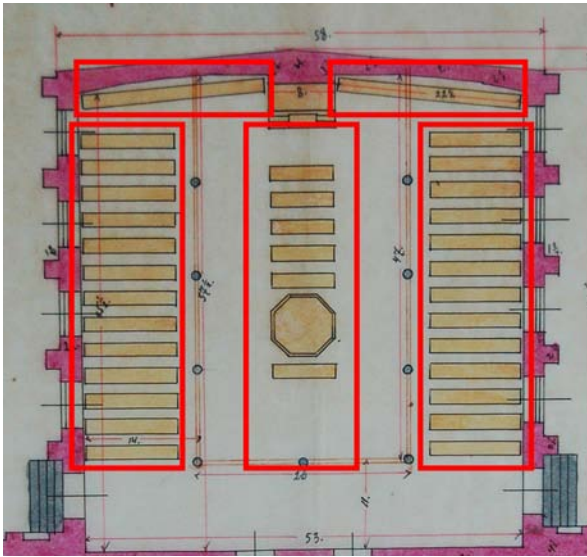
Markierungen der Sitzbänke, Plan EG, Archiv
